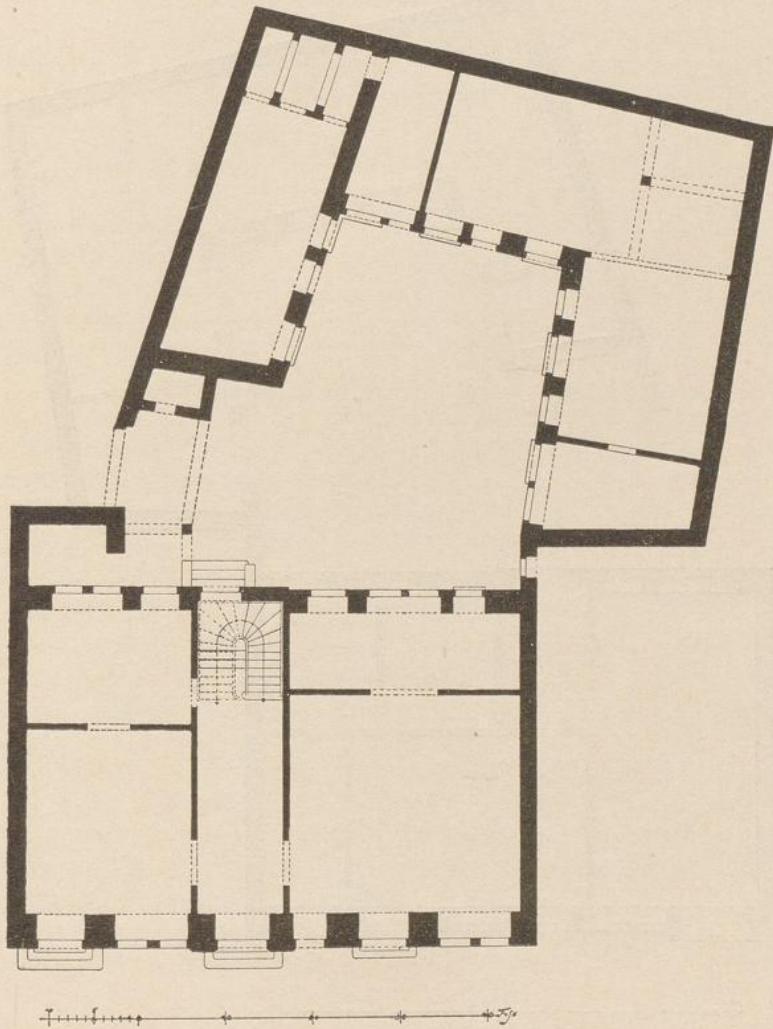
Engelthaler Hof; Grundriss des Erdgeschosses.
